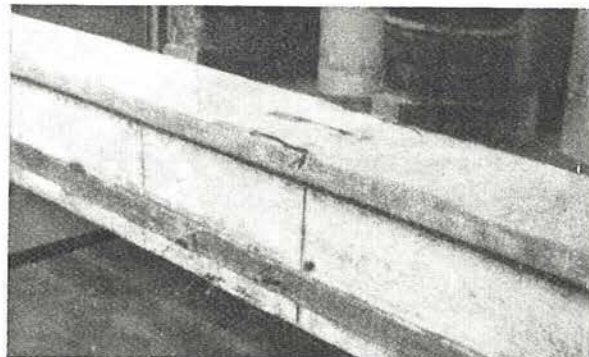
Elongómetros colocados en la sección de la viga correspondiente al centro de la luz.
